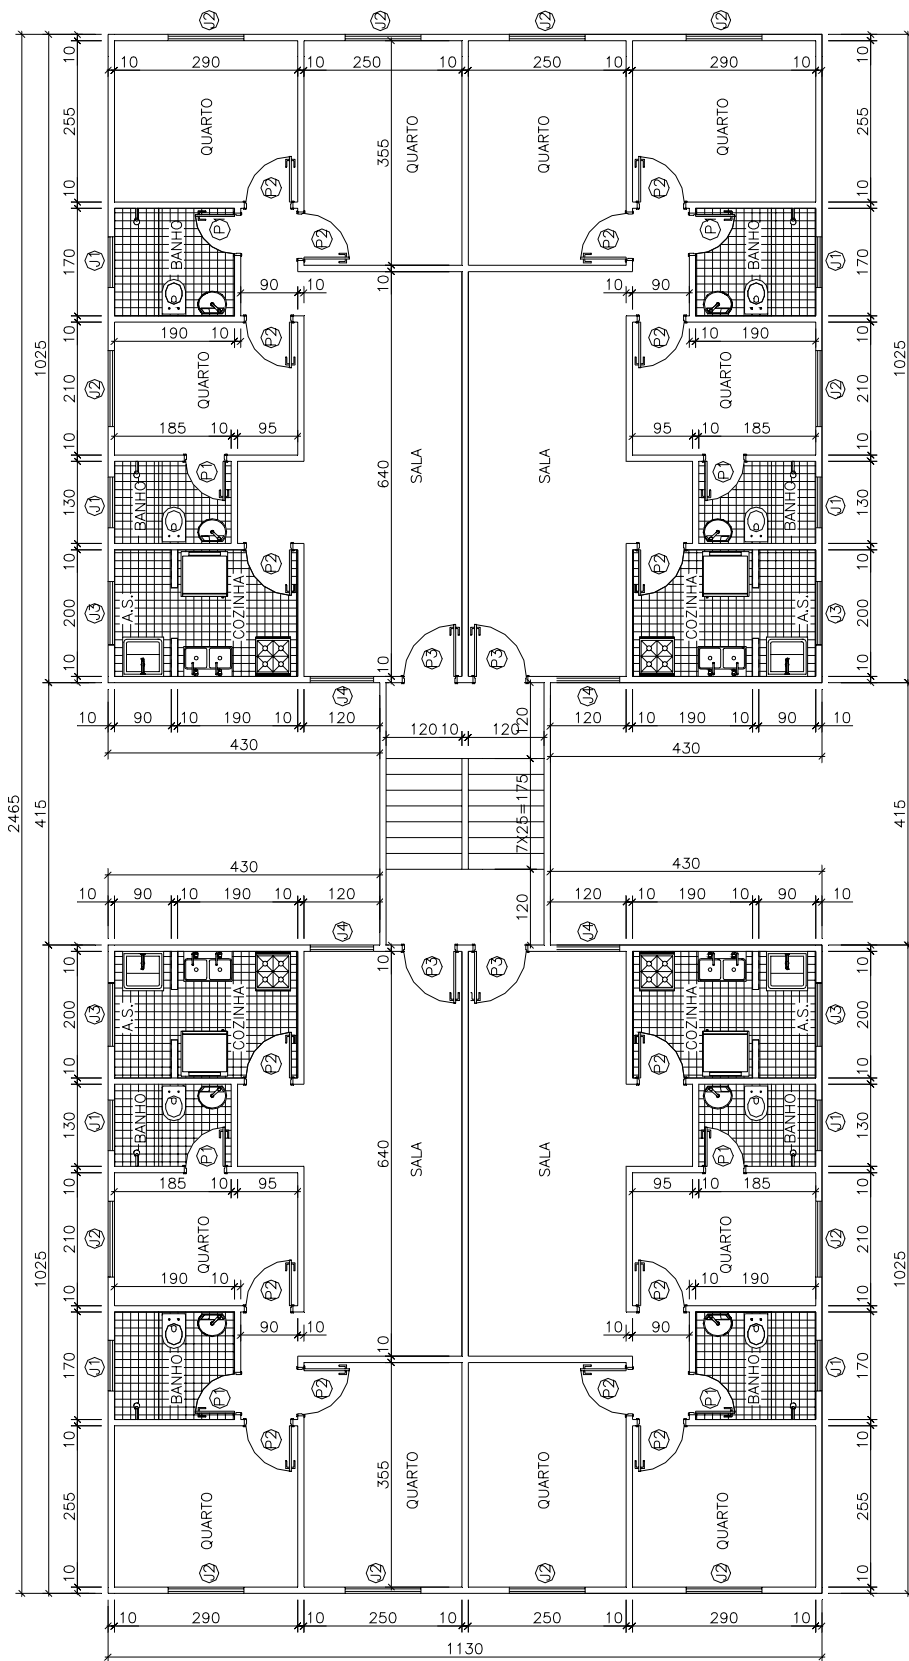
Residencial “G” – Pavimento Tipo
